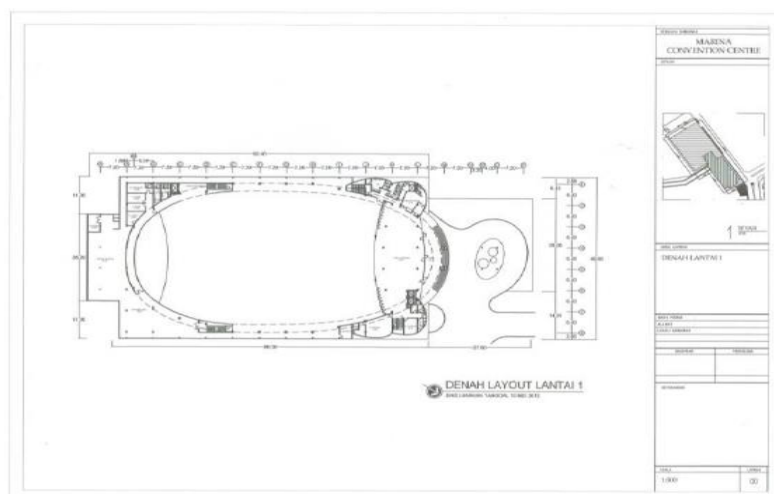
Struktur Kolom dan Balok Marina *Convention Center
